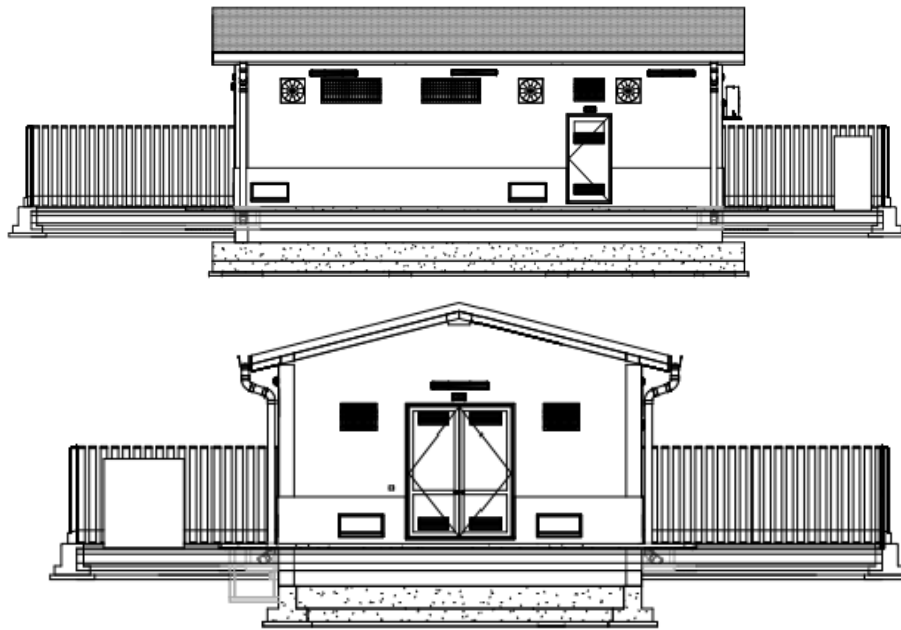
Sezione Piazzale CTE Valle Aurelia – vista 1- vista 2
